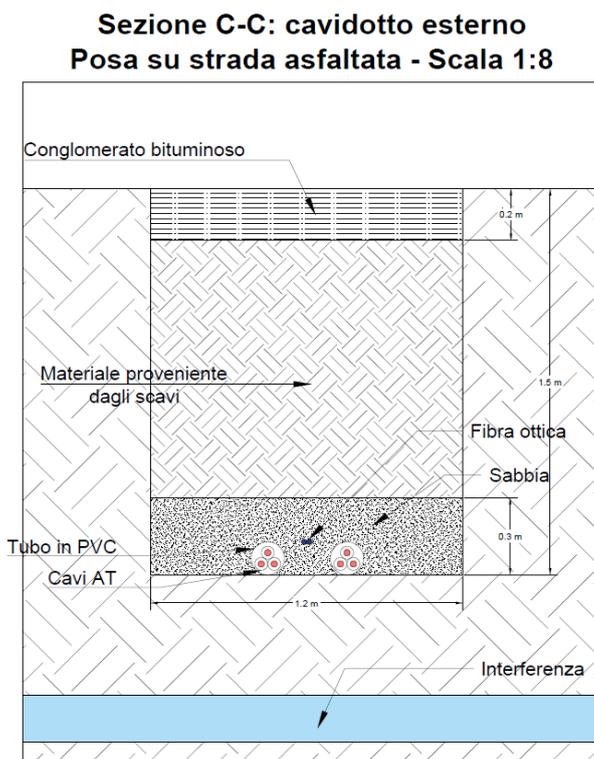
SEZIONE TIPO SCAVO SU STRADA
